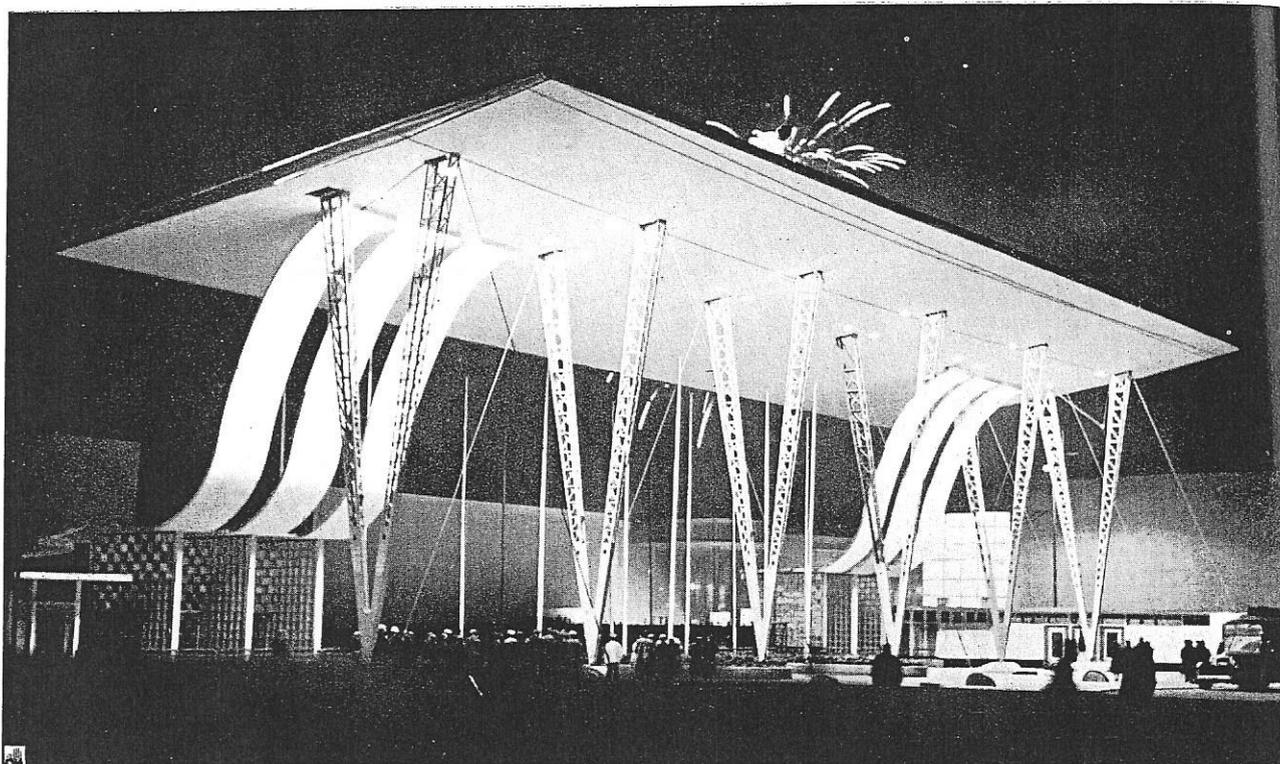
L'entrée Bressoux sur la rive droite est constituée par une sorte d'aile d'avion soutenue à grande hauteur par six portiques en V.
